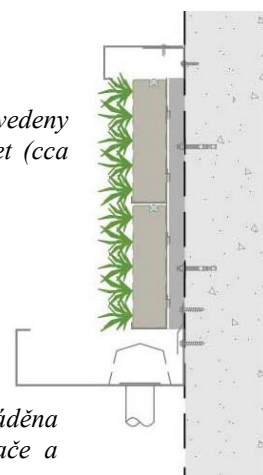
Zavěšování kazet systému PRO WALL na nosnou hliníkovou konstrukci [24]
